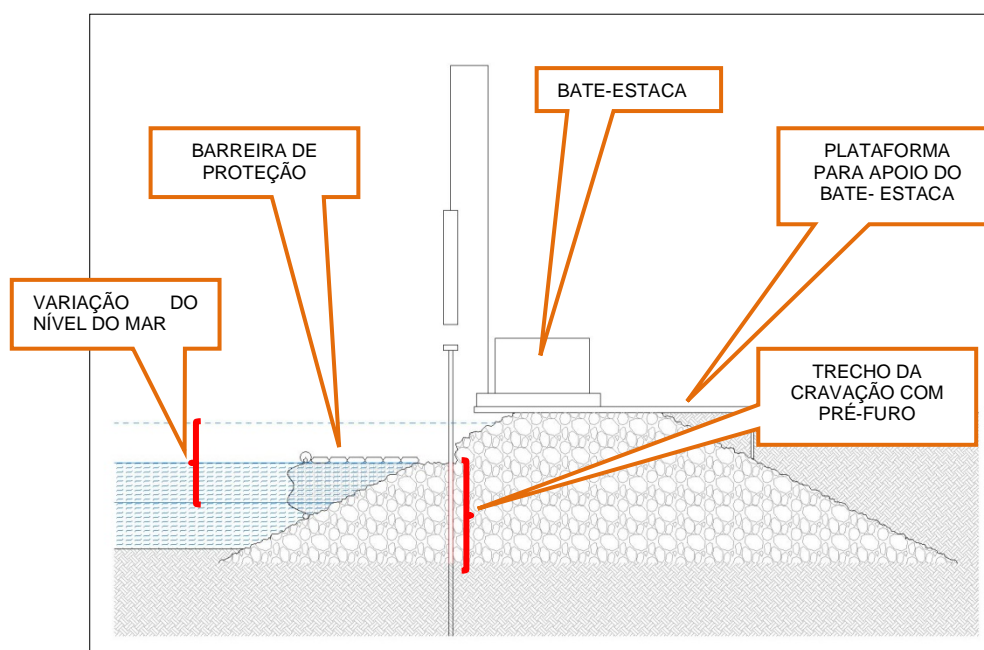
Croqui esquemático da plataforma de apoio do bate-estaca e barreira de contenção
